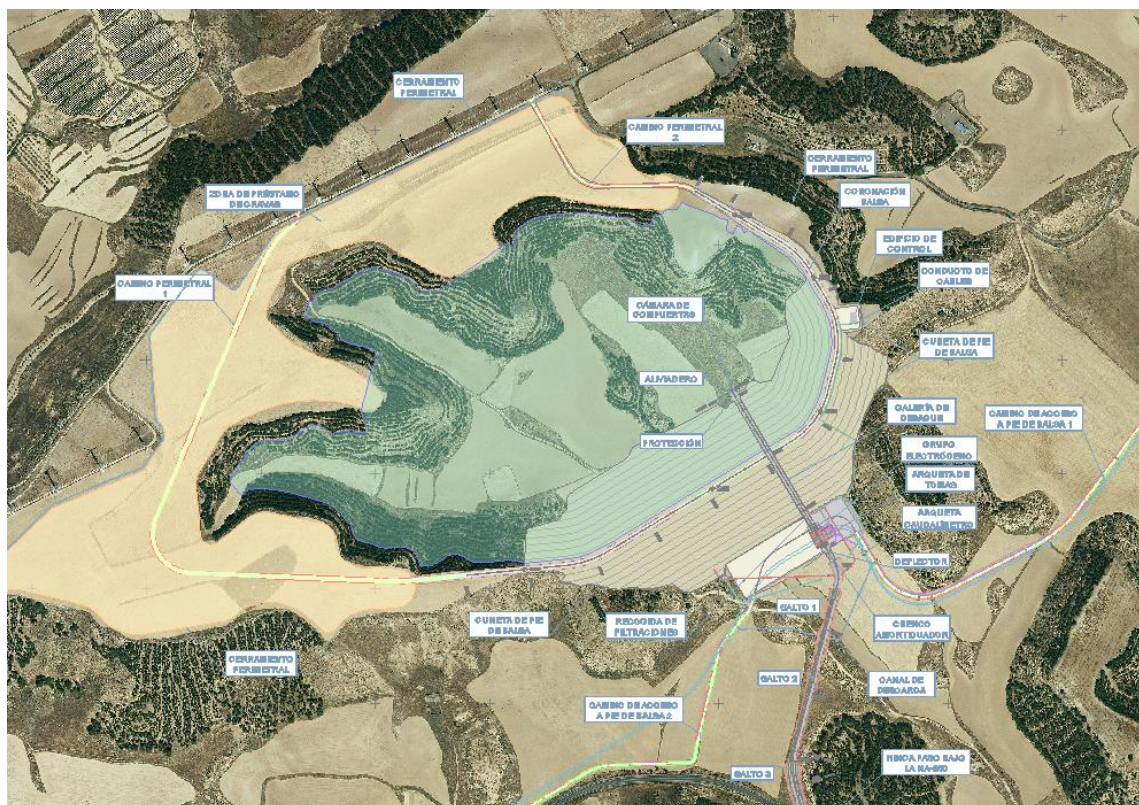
Planta general de los caminos de acceso de la balsa de Tudela.
